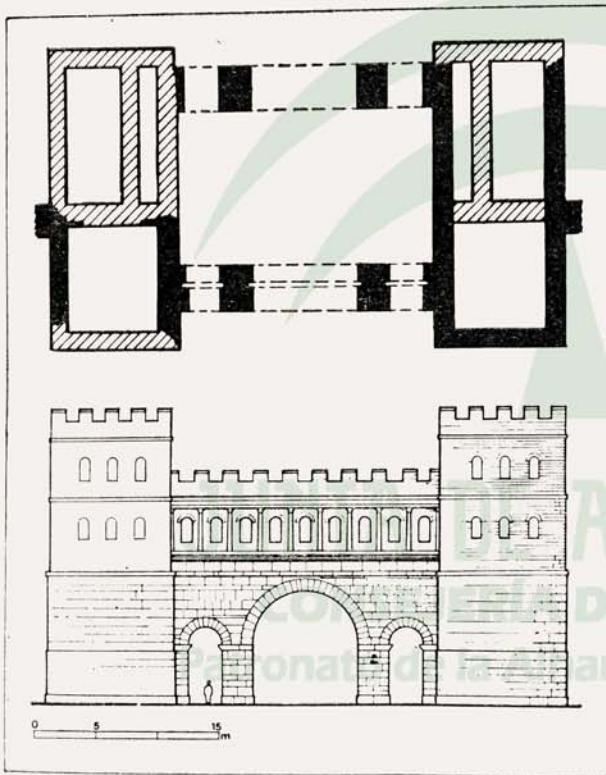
Aosta: Planta y reconstrucción del alzado de la puerta Pretoria
